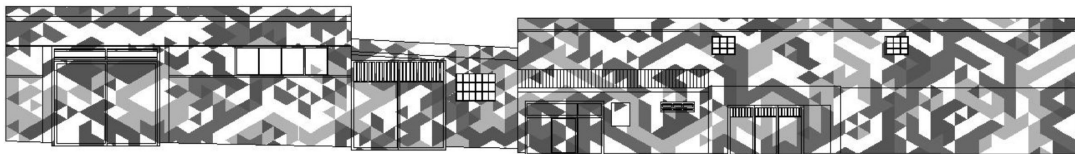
Alzado de la propuesta con el diseño del patrón. Fuente: R. Corbato
